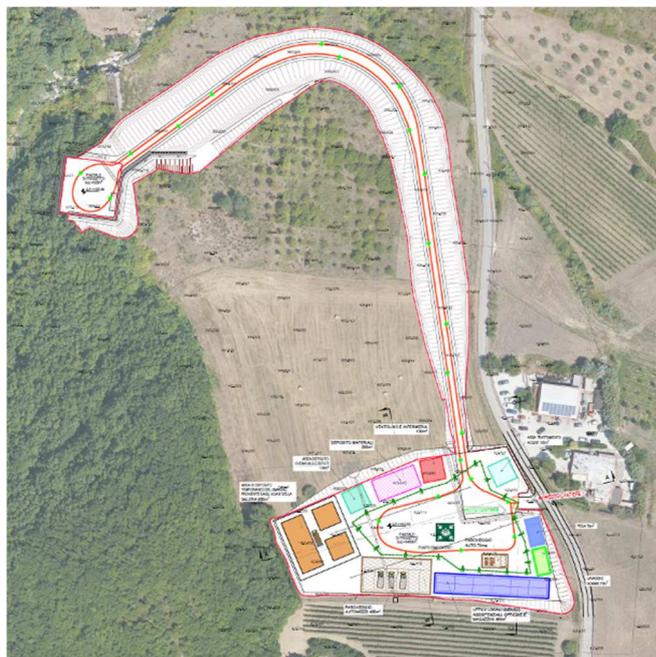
Layout cantiere scavo galleria discenderia laterale (COS2)
